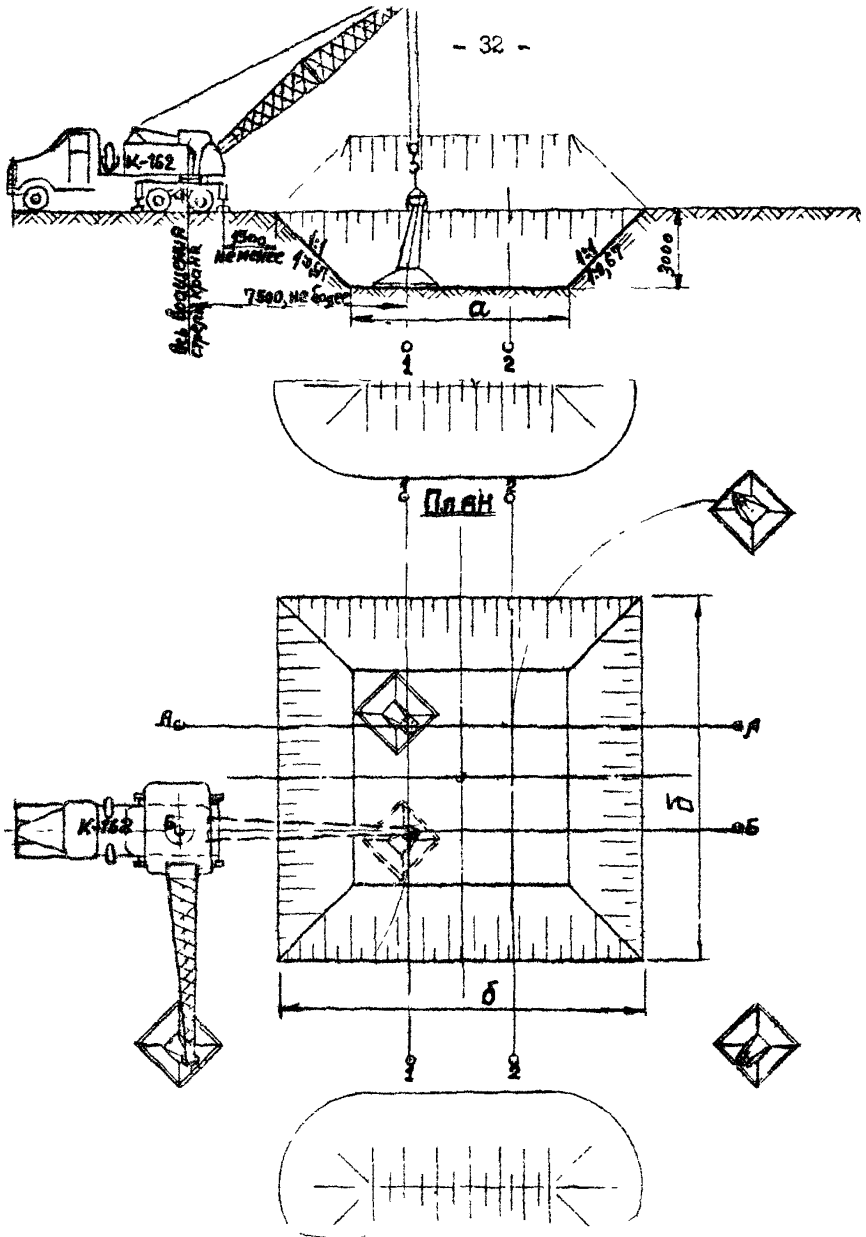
Схема установки железобетонных элементов фундамента для опор УЗ5-2, У110-1, У110-2. Автокран К-162
